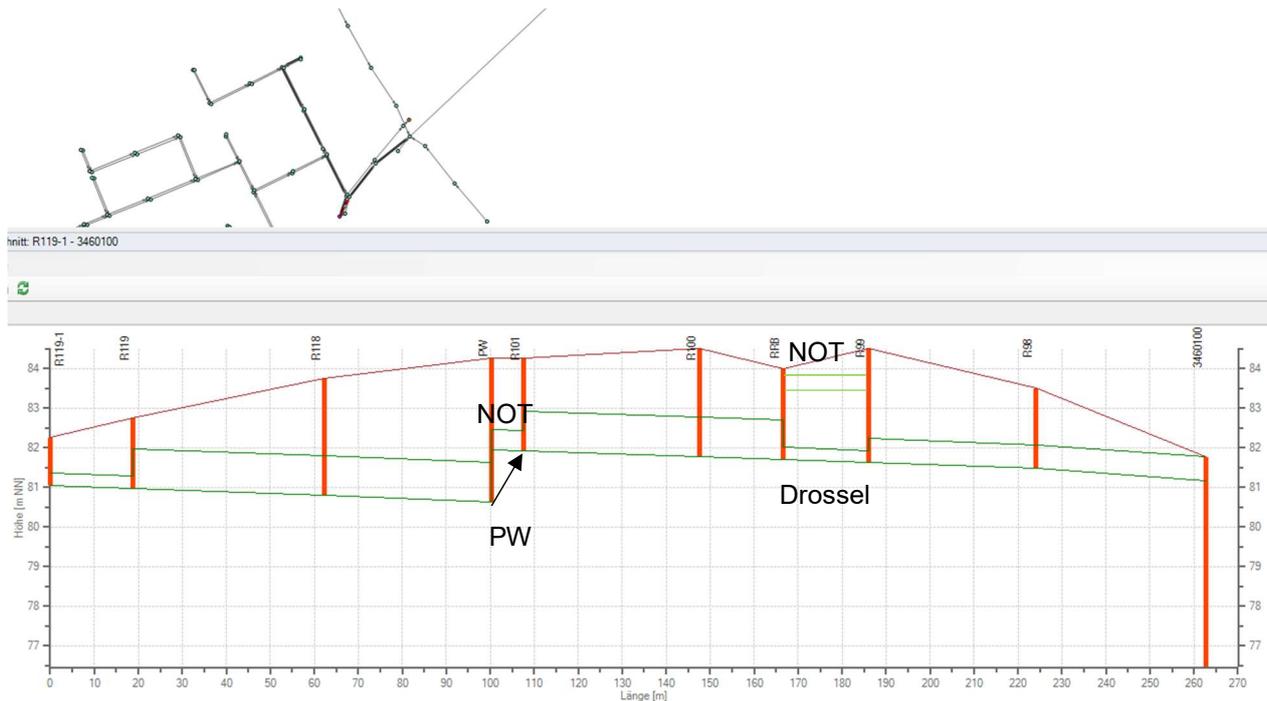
Variante 2: Längsschnitt R119-1 (Tiefpunkt) – 3460100 (Absturzbauwerk)
